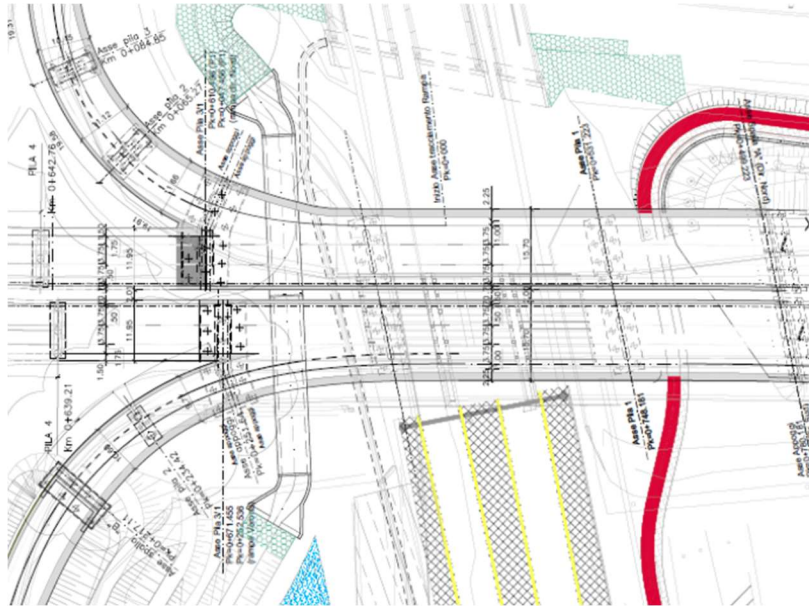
Planimetria Cavalcaferrovia Scaligeri
